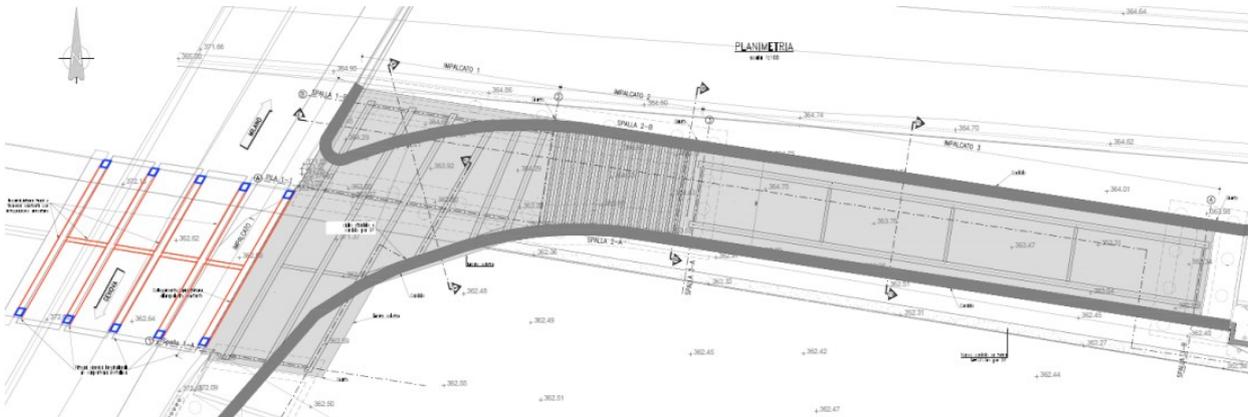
Dettaglio di planimetria di progetto (Fonte: Lista di controllo)
